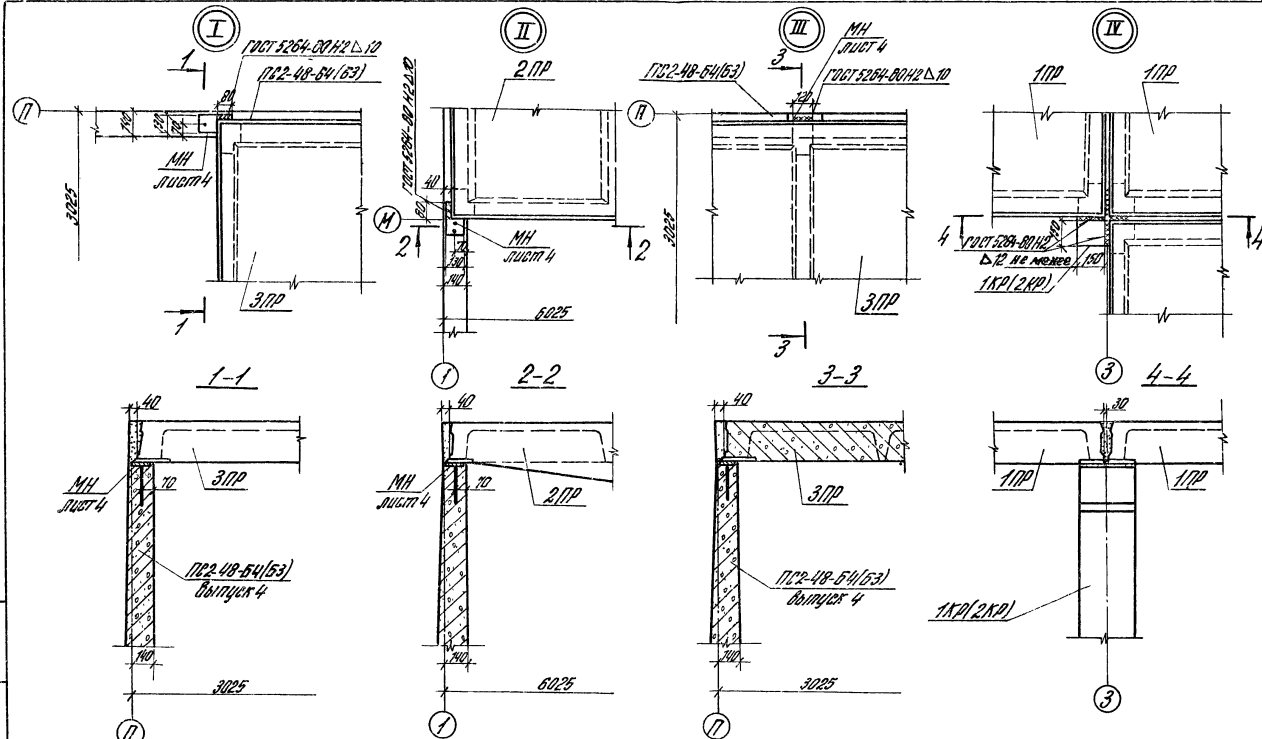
Сопряжение плит покрытия со стенами и колоннами
